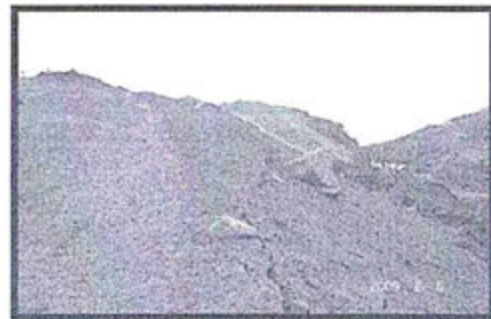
Se observa grietas en el talud del terreno donde se emplazará el nuevo depósito de mineral.
